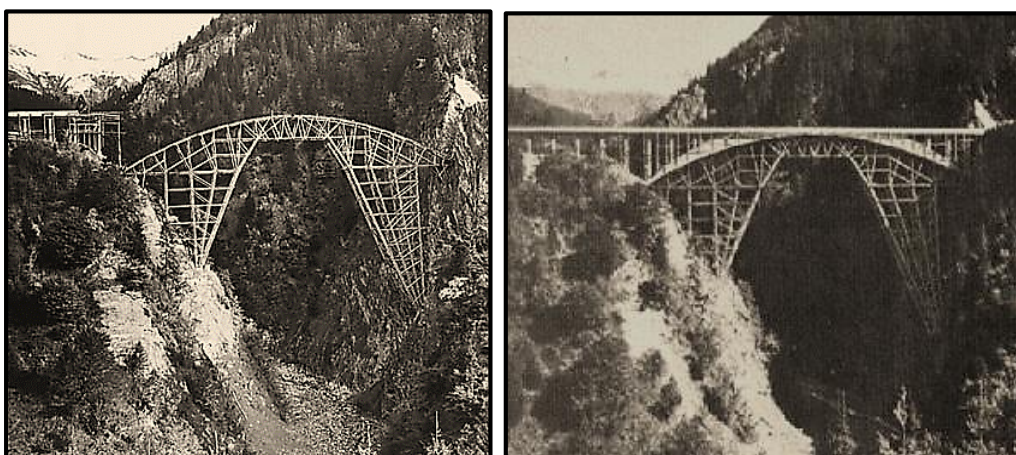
Cimbra de madeira da Ponte Salginatobel. À esquerda, antes da betonagem do arco e do troço do tabuleiro correspondente. À direita após a betonagem do arco e do tabuleiro.
